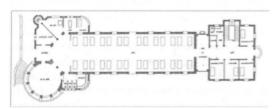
Planta baja del pabellón de San Manuel (AHSCP)
